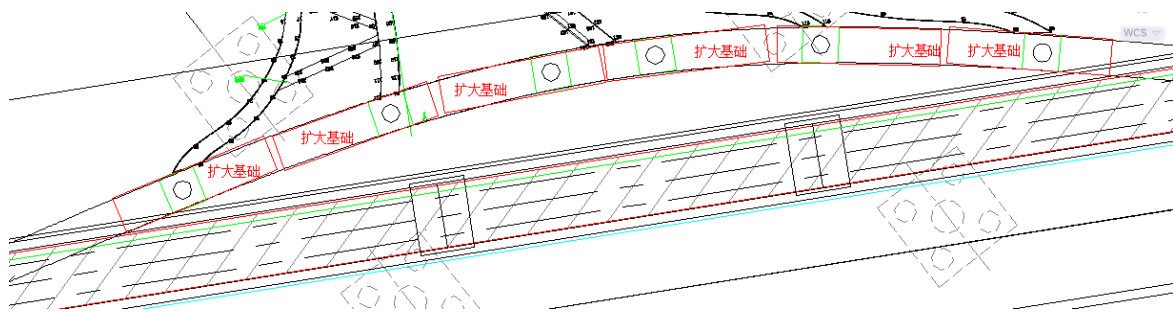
景观拱扩大临时支撑底座平面图(单位: mm)
